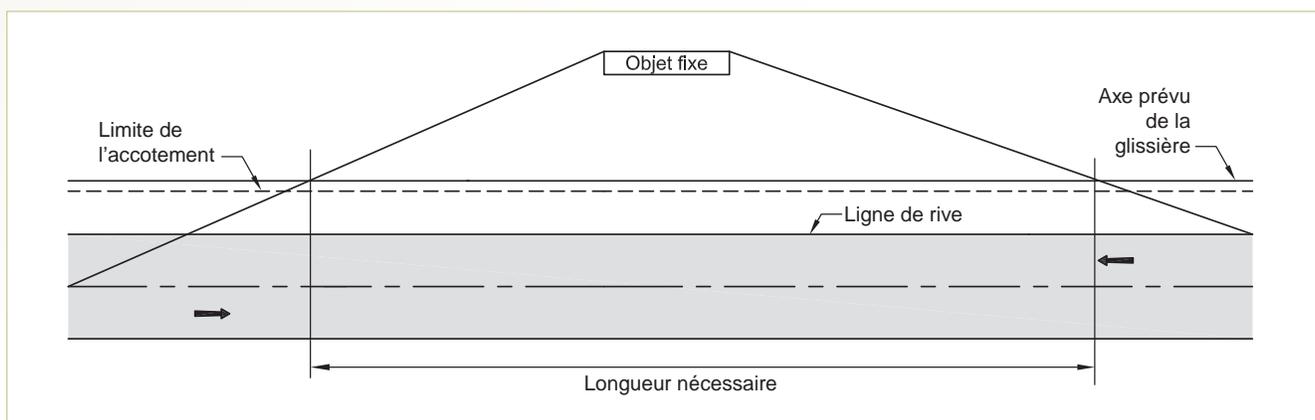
Détermination de la longueur nécessaire d'une glissière
